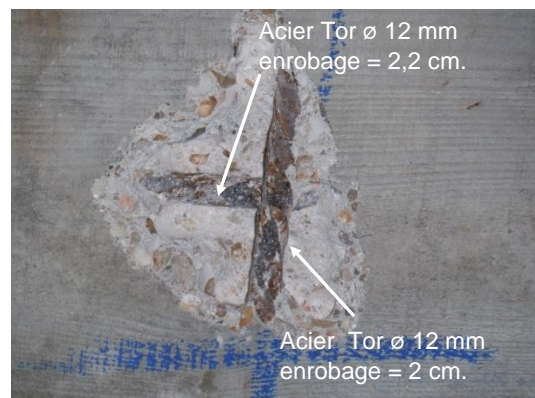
ouverture sur aciers en sous-face de la dalle
